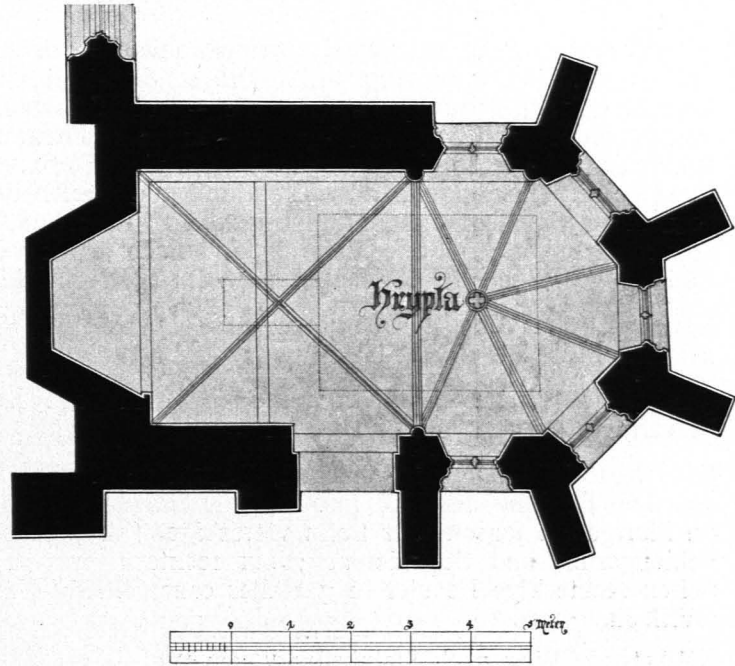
Säusenstein, Loretokapelle, Grundriß (S. 413)
